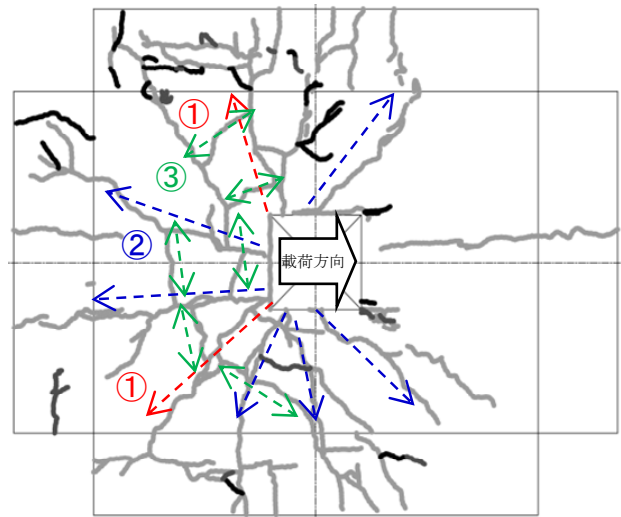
フーチング上面のひび割れ状況(実験終了時)
